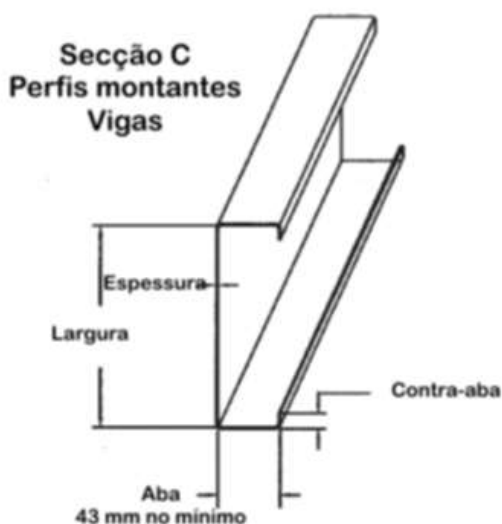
Dimensões de LSF (Fonte: Futureng.pt)
